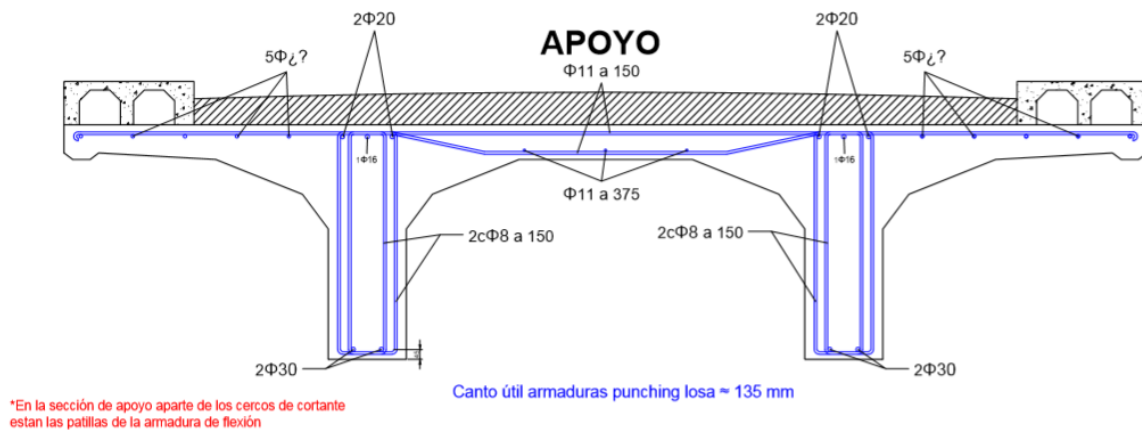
Detalle de armado de la pieza cortada en los apoyos del vano
